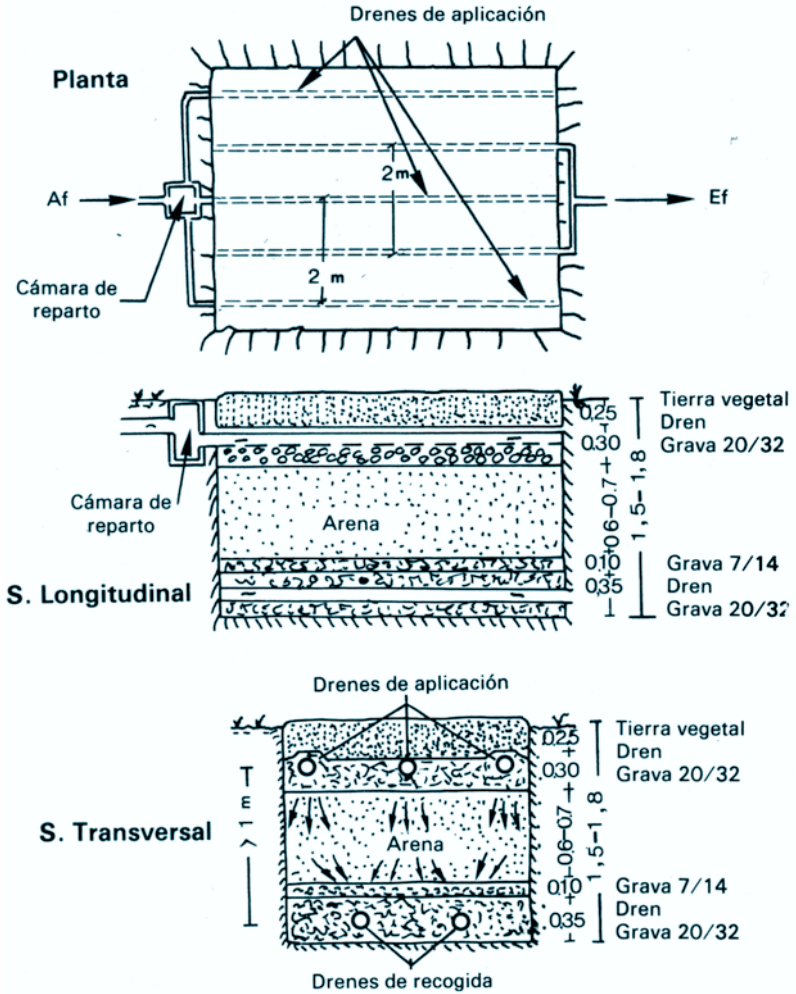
Características constructivas de un filtro intermitente de arena enterrado (Rouhart, J., 1986)
